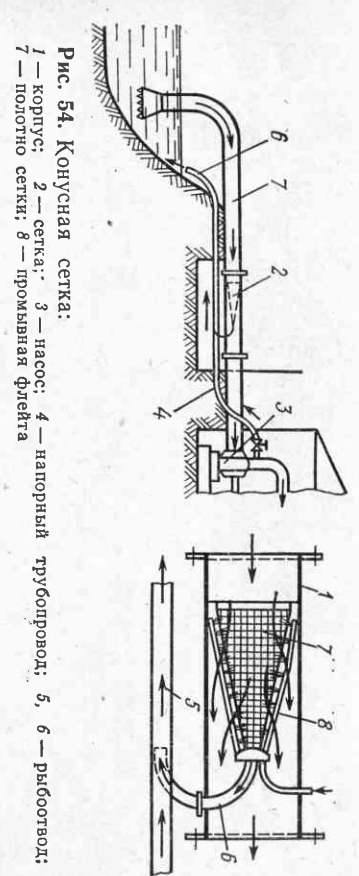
Конусная сетка: 1 — корпус; 2 — сетка; 3 — насос; 4 — напорный трубопровод; 5, 6 — рыбозащиты; 7 — полотно сетки; 8 — промывная флейта
